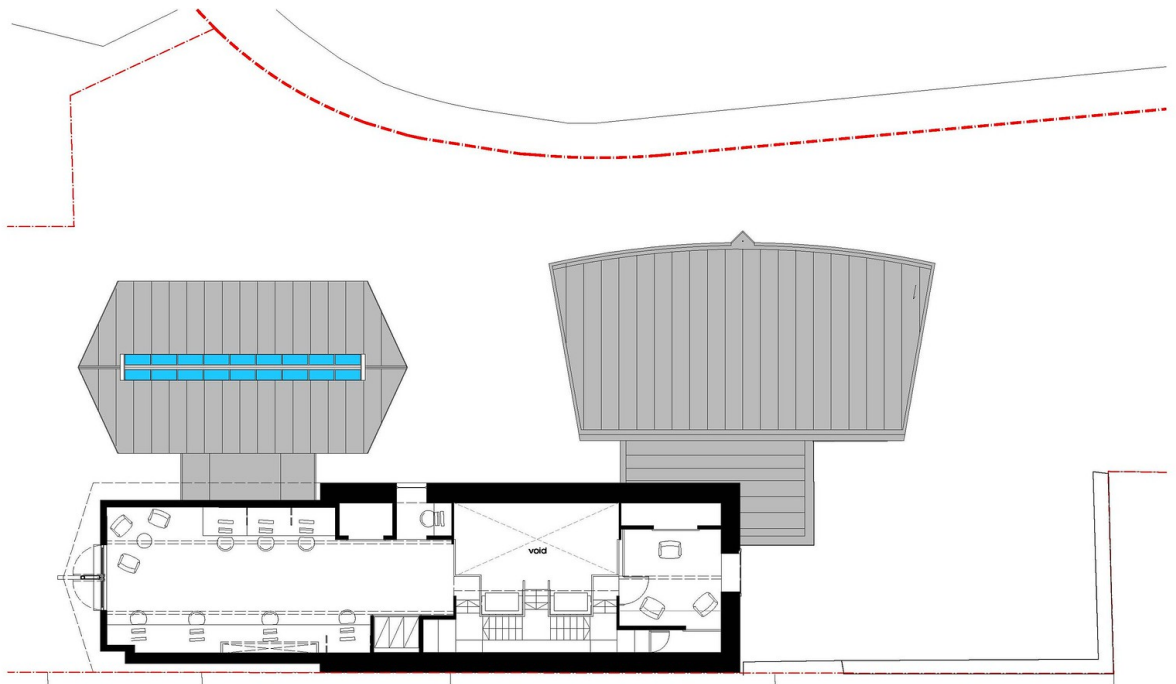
Planta Baixa Pavimento 1º do Maggie's Center Edinburg - Projeto de Richard Murphy Architects- Fonte: <https://www.richardmurphyarchitects.com/Maggies-Cancer-Caring-Centre-Edinburgh> - acessado em 05.05.2023
